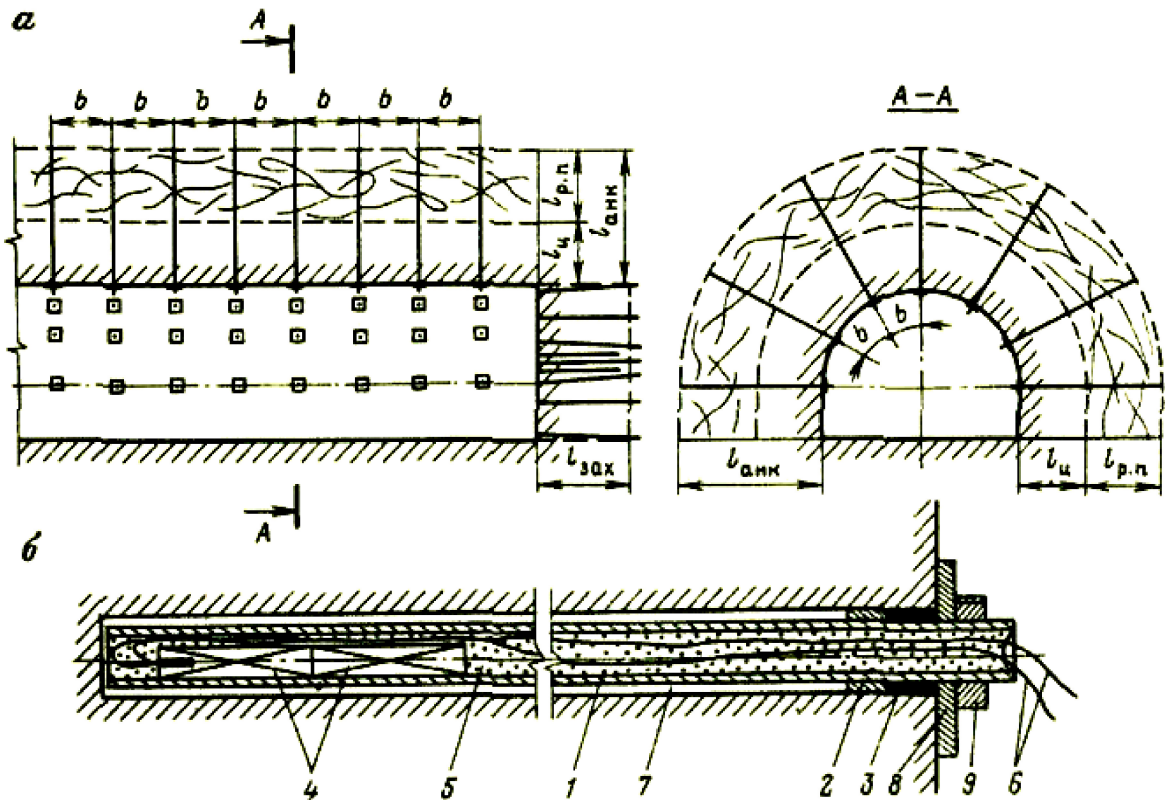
Схема проведения выработки с использованием способа «крепь-охрана» (а) и конструкция заряда ВВ (б): 1 – трубчатый анкер; 2 – гайка стопора пакера; 3 – пакер; 4 – патроны ВВ; 5 – песчано-глинистая забойка; 6 – провода электродетонаторов; 7 – шпур; 8 – опорная плита; 9 – натяжная гайка
